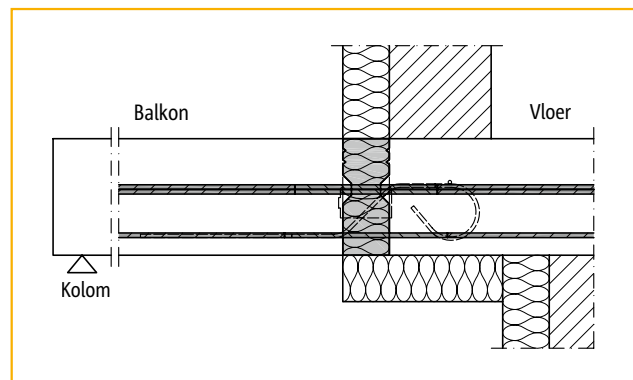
Dragend metselwerk bij een doorgestort balkon met Schöck Isokorf® type Q+Q en EQ1-module
